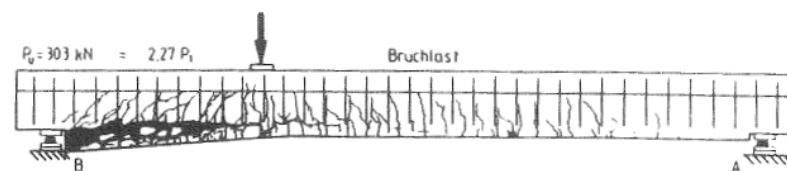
Rißbilder Balken VB2, Versuchslauf 1 (l = 5 m)
